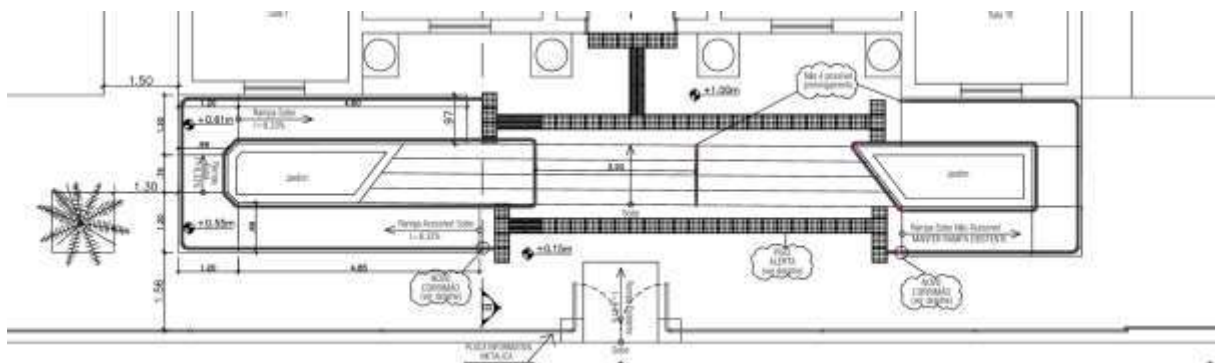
Detalhamento da rampa de acesso (sem escala)
